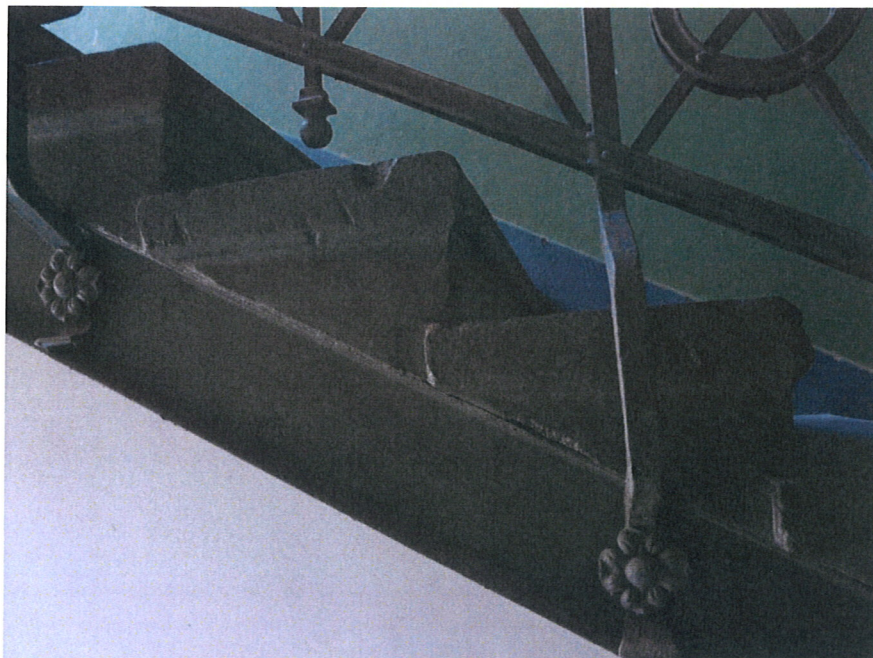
Betonowa klatka schodowa. Zabrudzone ściany i sufit.
